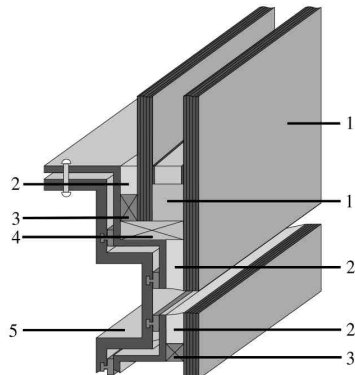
A: Detalle del travesaño. Ejemplos de diseños de acristalamiento estructural: diseño de 2 lados (instalado en obra).
